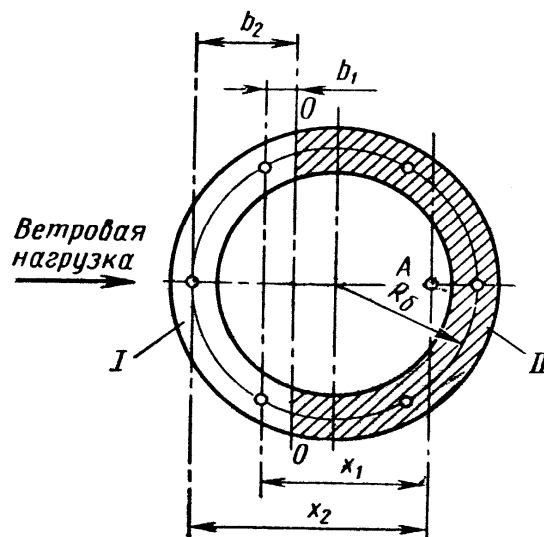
Схема расположения фундаментных болтов (I и II – соответственно растянутая и сжатая зона; R_6 – радиус окружности фундаментных болтов).
